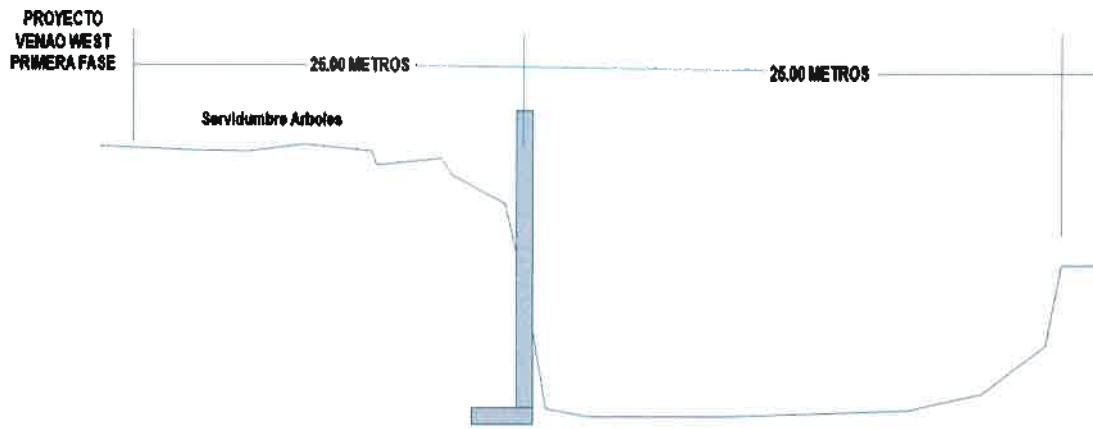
Concepto de Retiro Según los planos Mostrados
